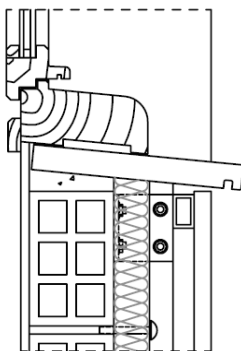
Sección tipo de un encuentro de carpintería con mampostería.
